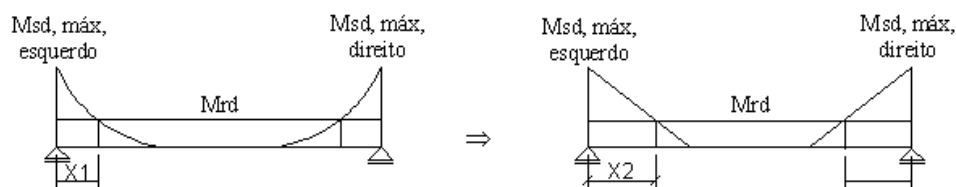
Simplificação do cálculo da dispensa de armadura.
